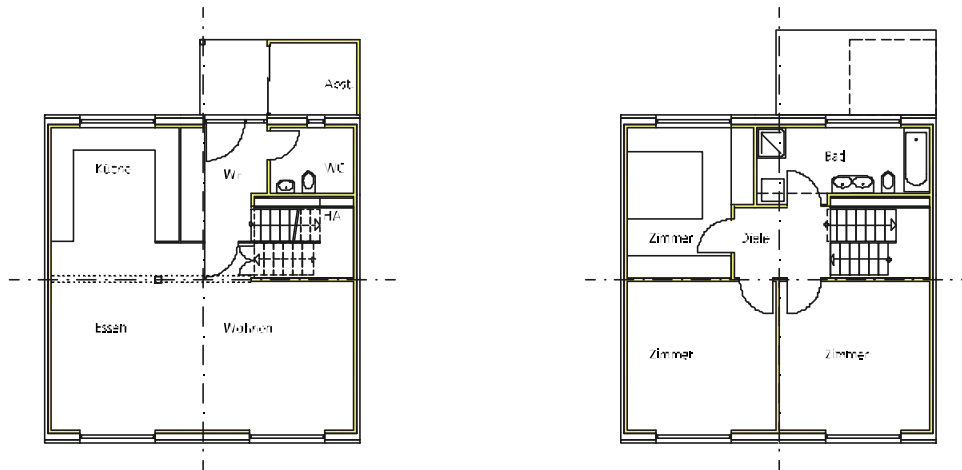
Grundrissvarianten EG und OG, M 1:200
